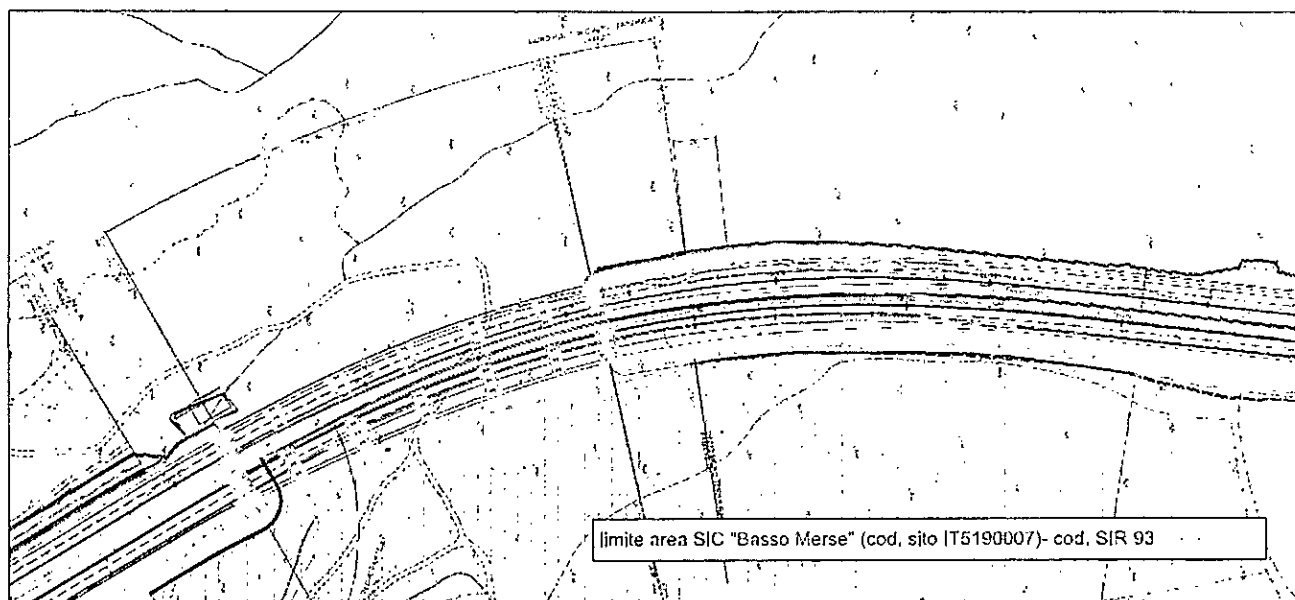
Stralcio planimetrico -Sistemazione carreggiata sinistra – Progetto Esecutivo TR22
